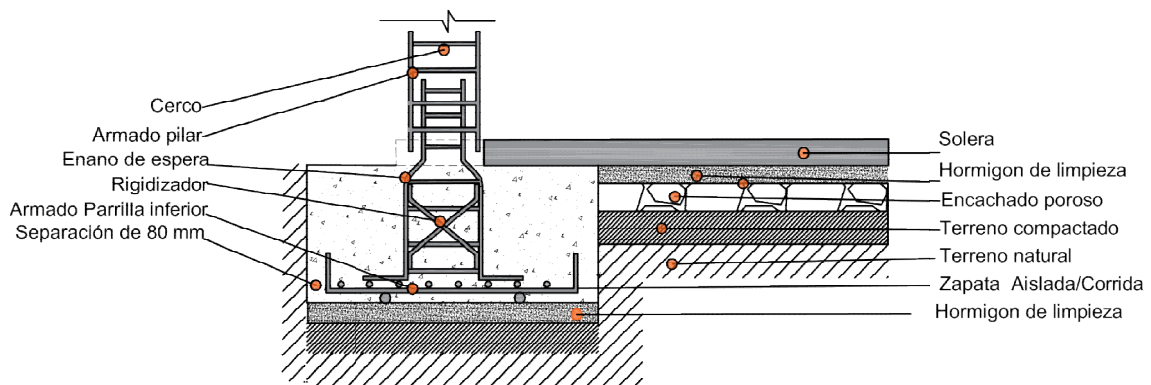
Hipótesis de sección zapata, zapata corrida. Cimentaciones. (Fuente autor).
